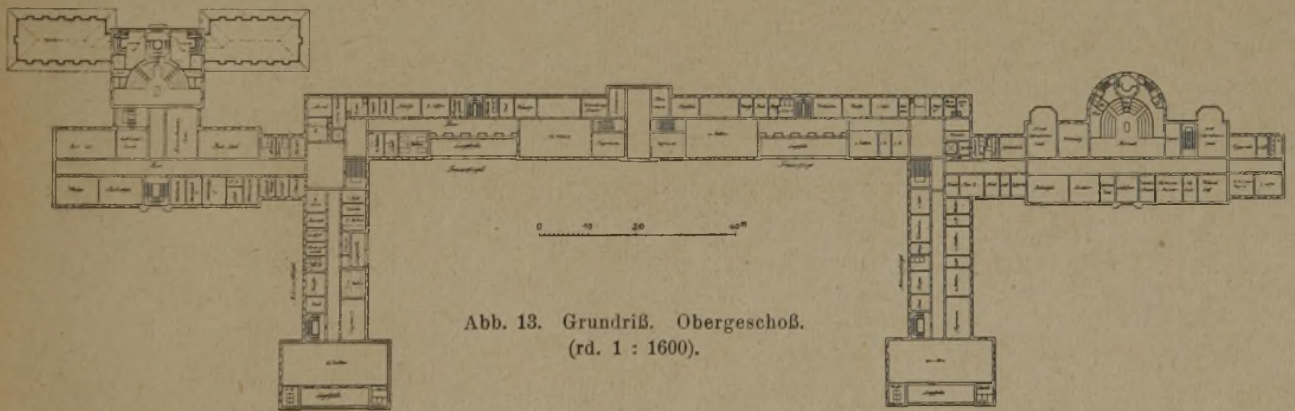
Grundriß. Obergeschoß. (rd. 1 : 1600).
